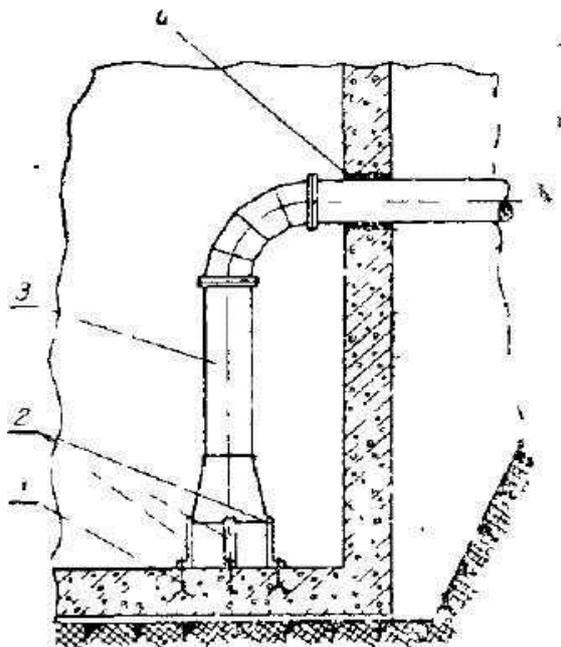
Крепление всасывающей трубы в водоприемной камере на стальной раме к стене водоприемной камеры
